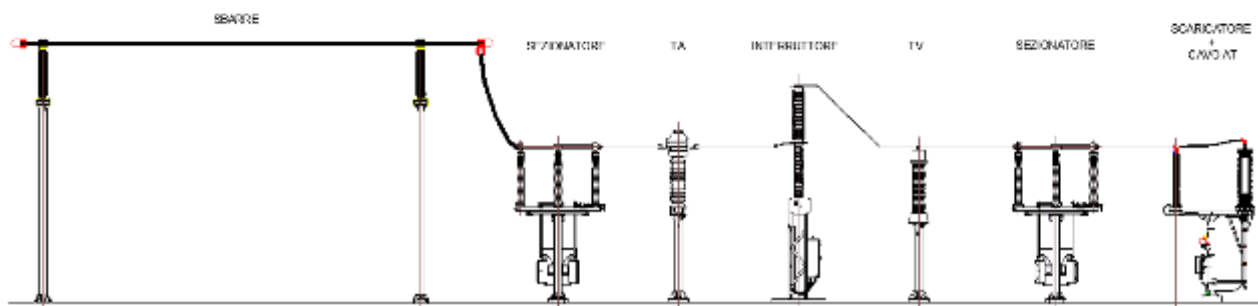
Sezione Longitudinale elettromeccanica stalli AT 150kV (SSE Utente)
